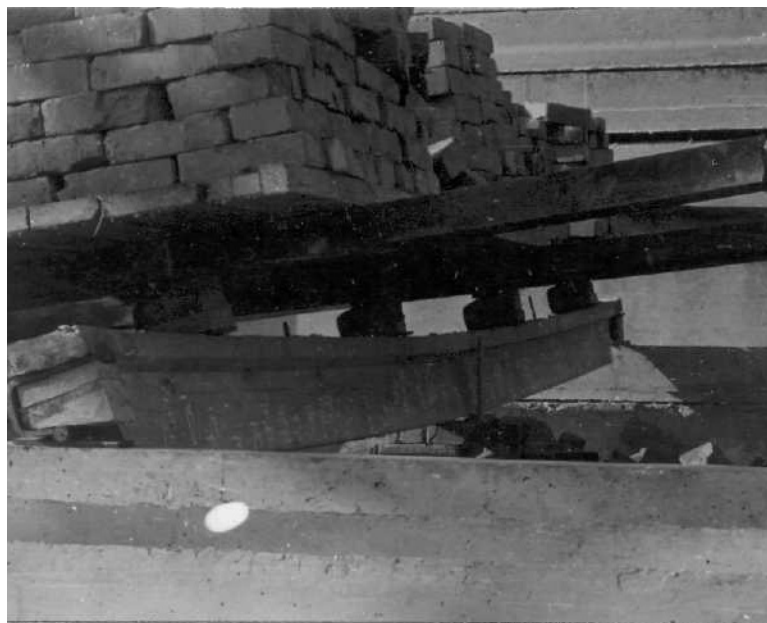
Залізобетонні таврові прогони в процесі випробувань
